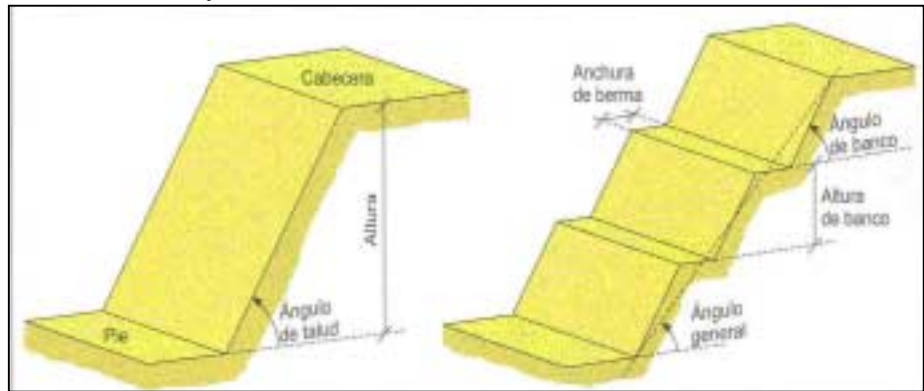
Talud con ángulo uniforme y talud excavado con bermas y bancos.
